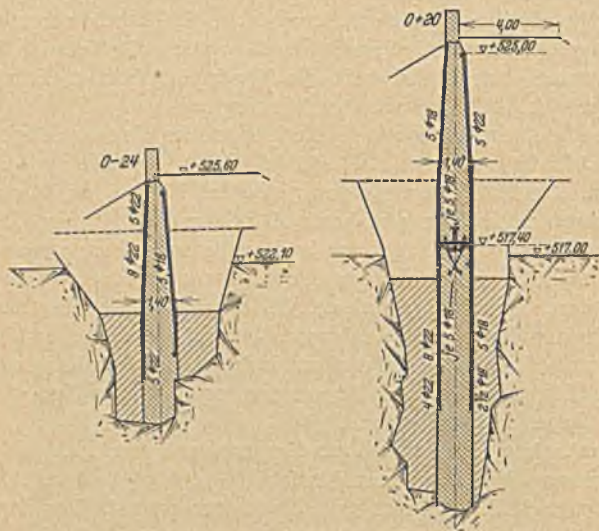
Schnitte durch den Betonkern mit Bewehrung.
